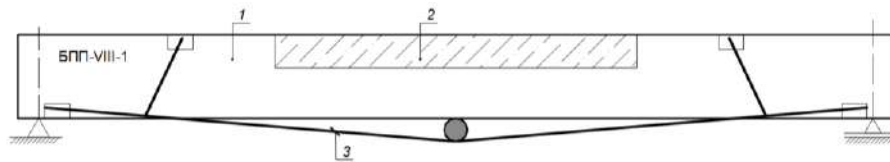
Схеми підсилення балок БПП-VIII-1: 1- дослідна балка; 2- пресований залізобетонний вкладиш; 3- зовнішня система армування
